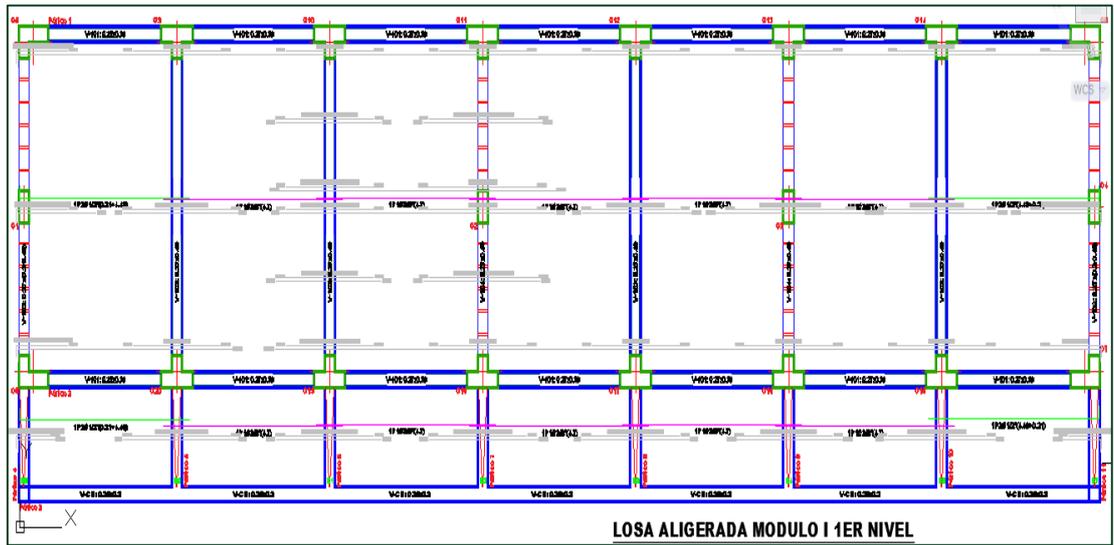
MODELO DE LOSA ALIGERADA PRIMER PISO DEL MODULO I
